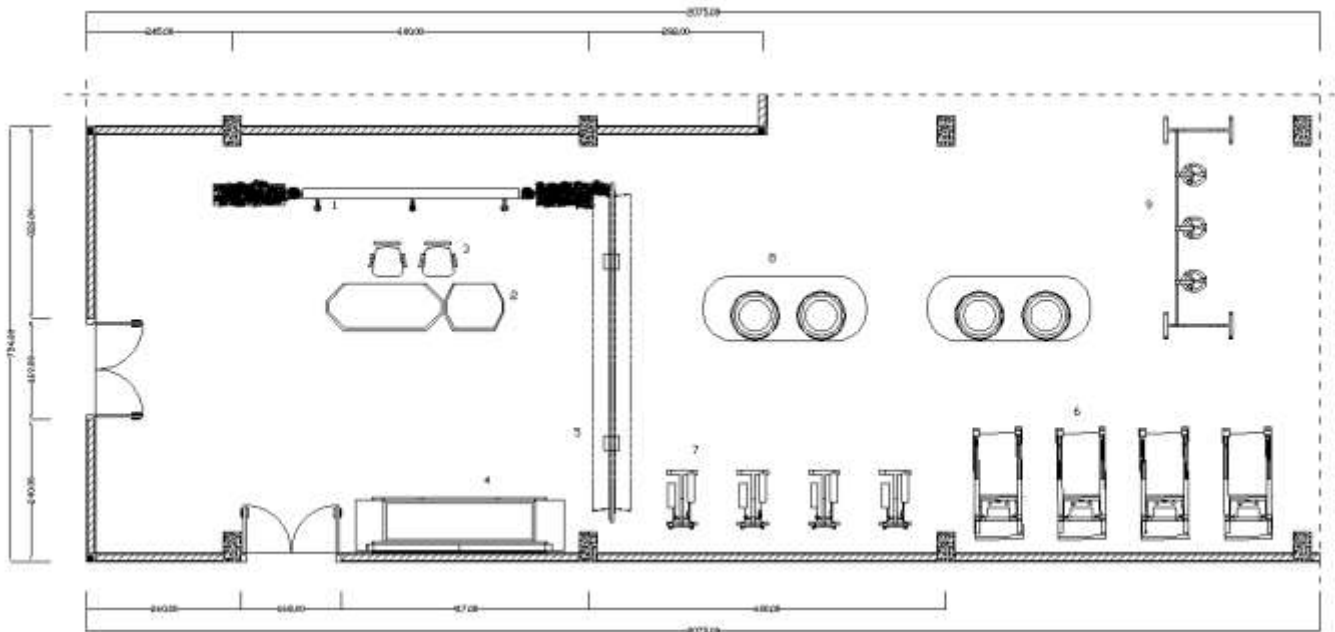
Detail elemen estetis area terpilih 1
